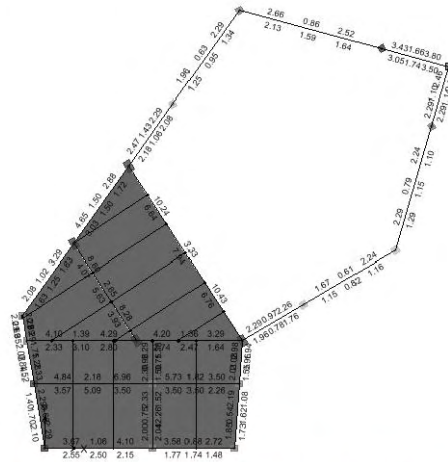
Refuerzos longitudinales en vigas – Piso 01
